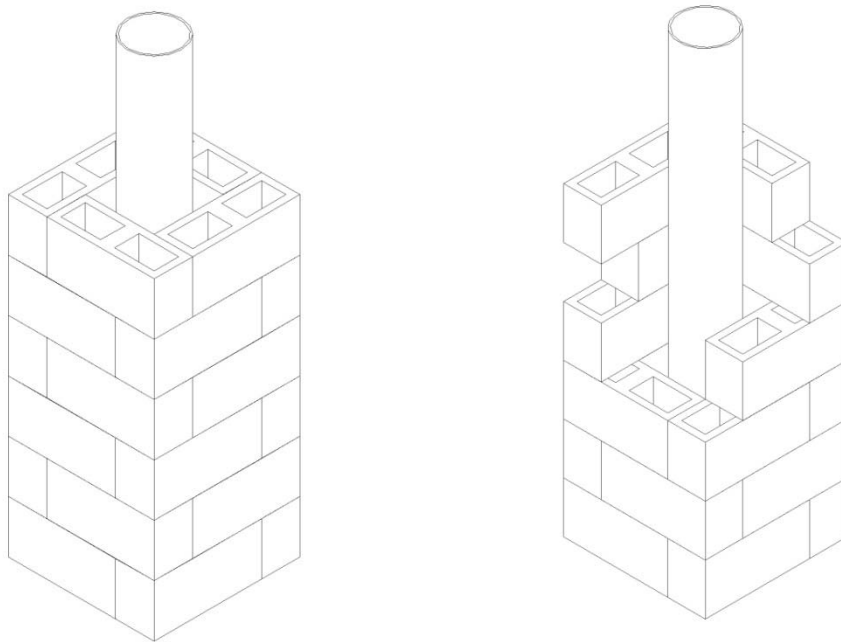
, levantado de mampostería como blindaje contra fuego para acero estructural
